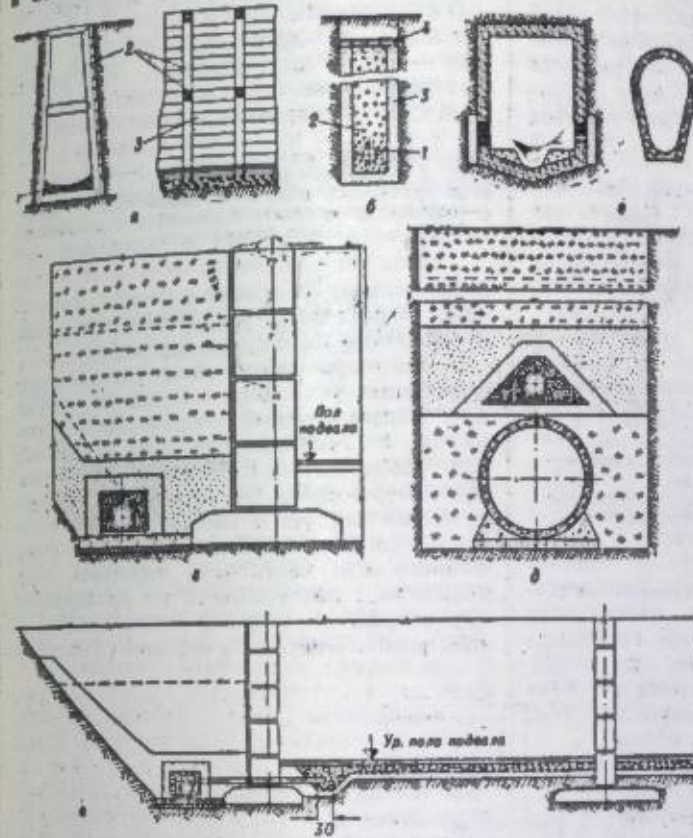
Типы горизонтального дренажа: а — дренажный лоток (1 — бетонный лоток; 2 — железобетонные рамки; 3 — железобетонные доски); б — трубчатые дрены (1 — дренажная труба; 2 — гравий; 3 — крупнозернистый песок); в — галерейные дрены; г — пристенные дрены (у стен подвала зданий); д — дрены над водостоком; е — пластовые дрены (под полом подвала).
